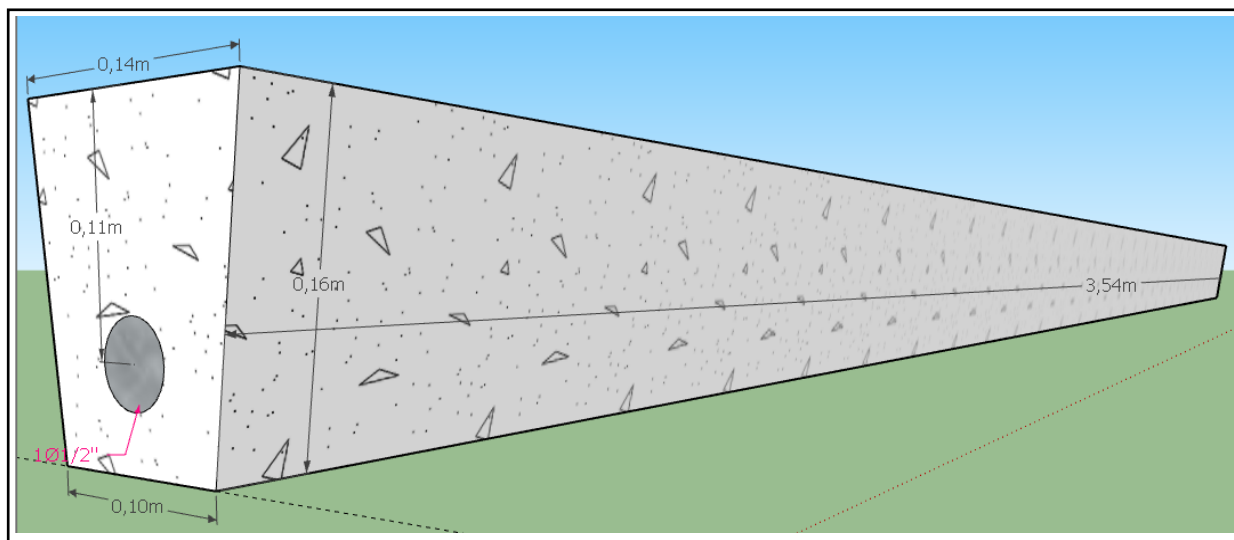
Vista en 3D de la vigüeta pretensada V1.
